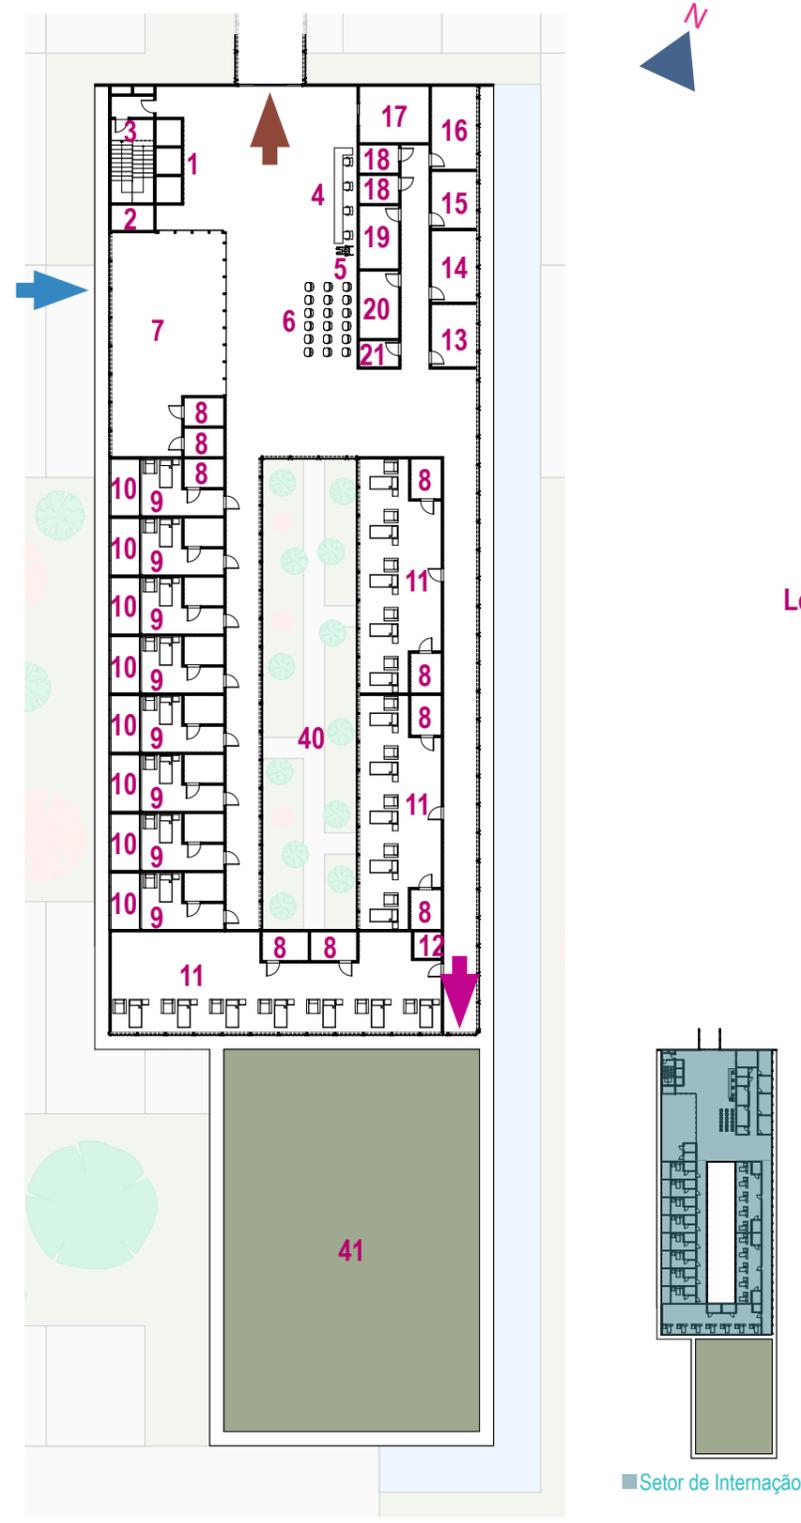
Planta Pav. Térreo (Bloco de Nutrição e Internação)
